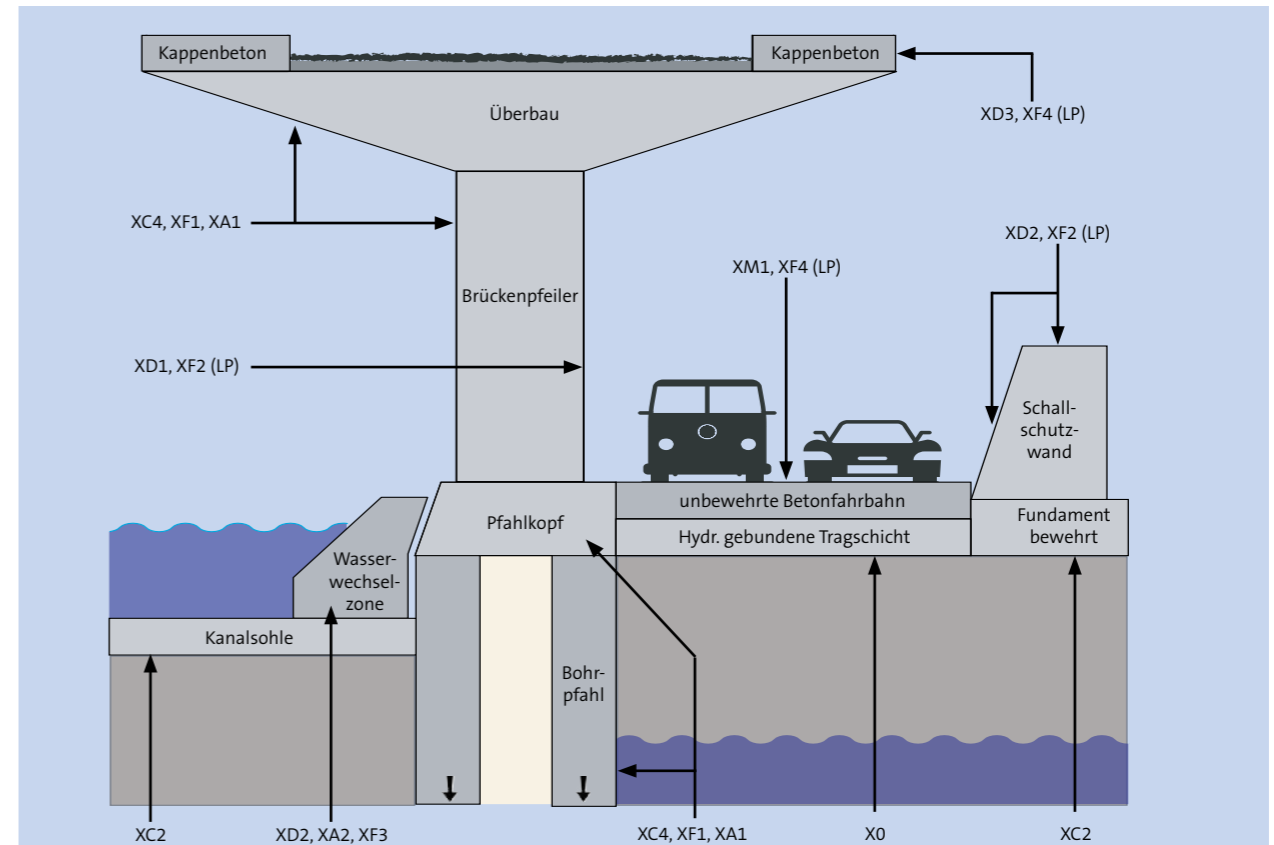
Expositionsklassen am Beispiel einer Prinzipskizze für den Ingenieurbau
